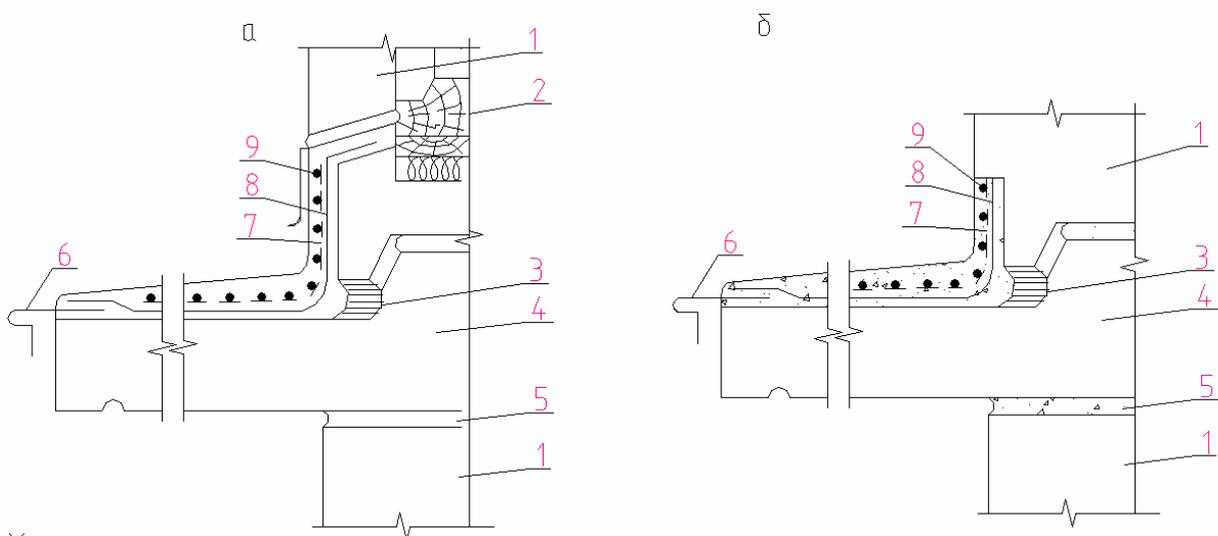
Герметизация мест примыкания балконной плиты к наружным стеновым панелям: *а* – сечение по проему; *б* – сечение по простенку; 1 – наружная стеновая панель; 2 – заполнение балконного проема; 3 – герметизирующая мастика; 4 – балконная плита; 5 – цементно-песчаный раствор; 6 – фартук из оцинкованной стали; 7 – цементно-песчаный стяжка; 8 – слой оклеечной гидроизоляции; 9 – сетка, армирующая стяжку
